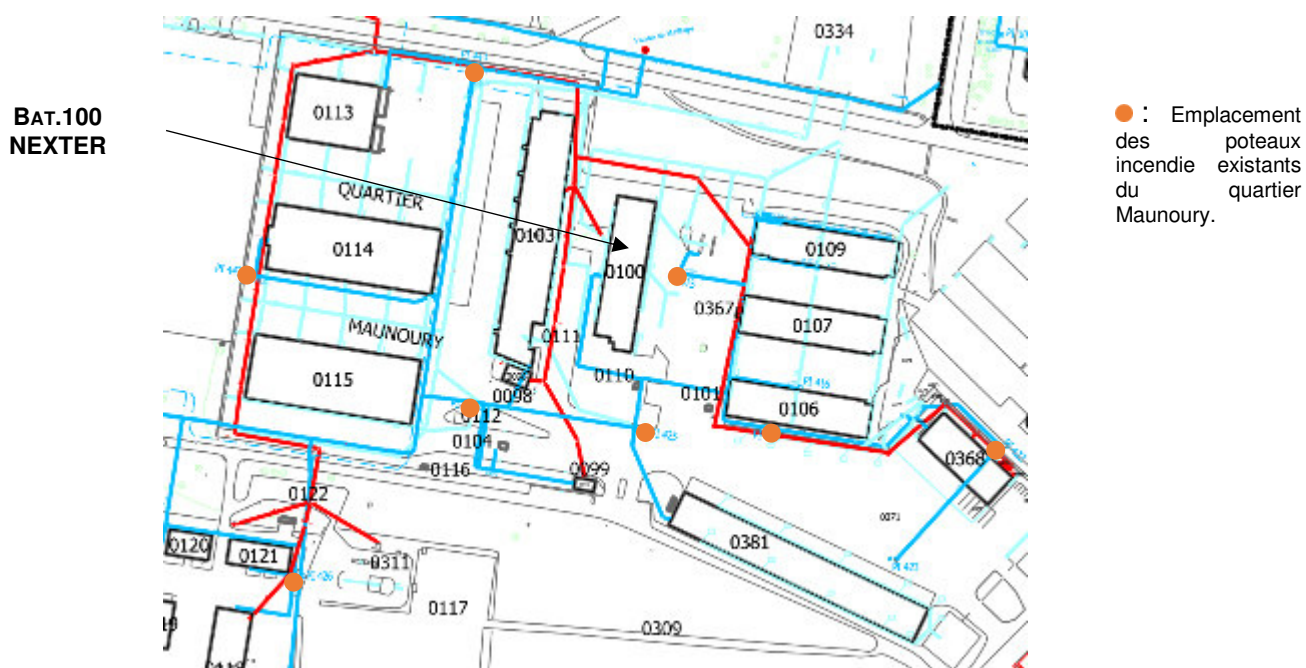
PLAN DE LOCALISATION DES POTEAUX INCENDIE (ECHELLE NON CONTRACTUELLE).
